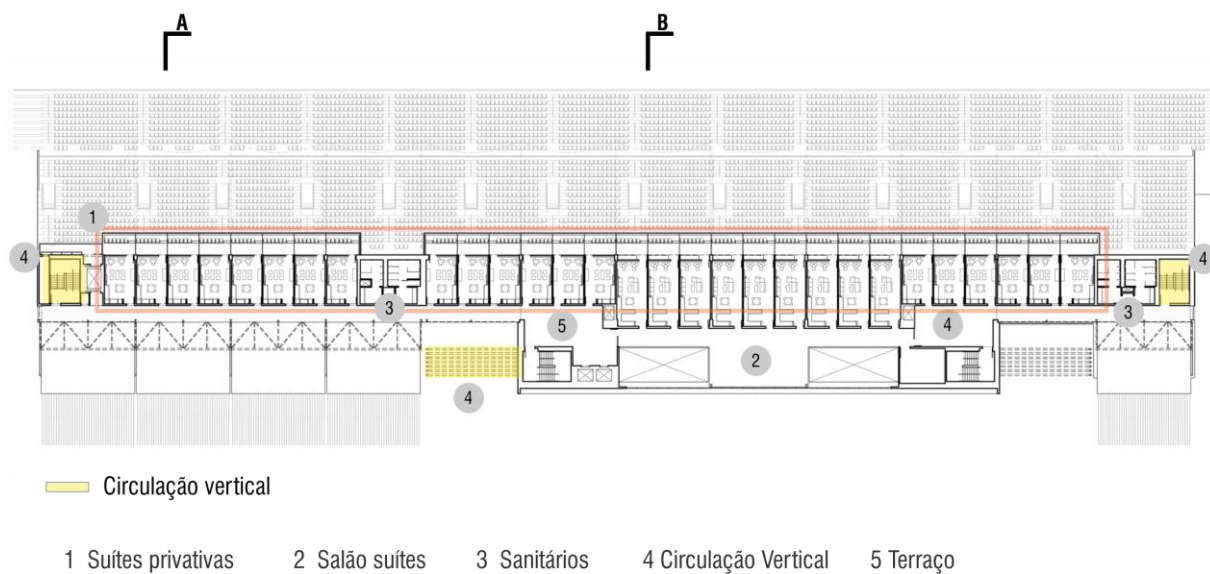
Planta baixa Arquibancada Principal - Nível 03
